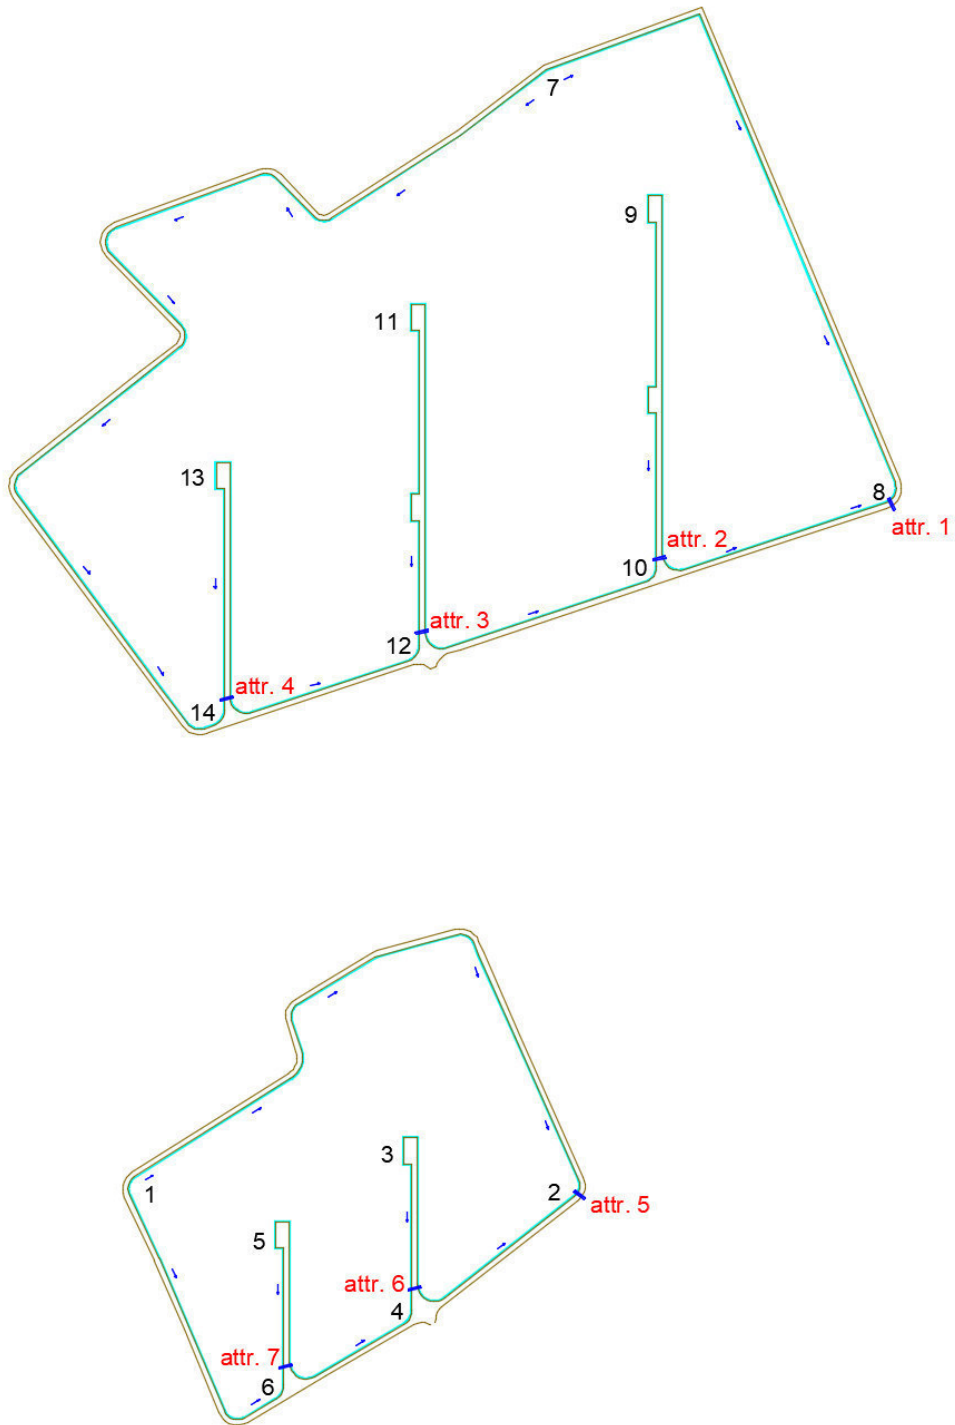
Planimetria delle cunette e attraversamenti viabilità
